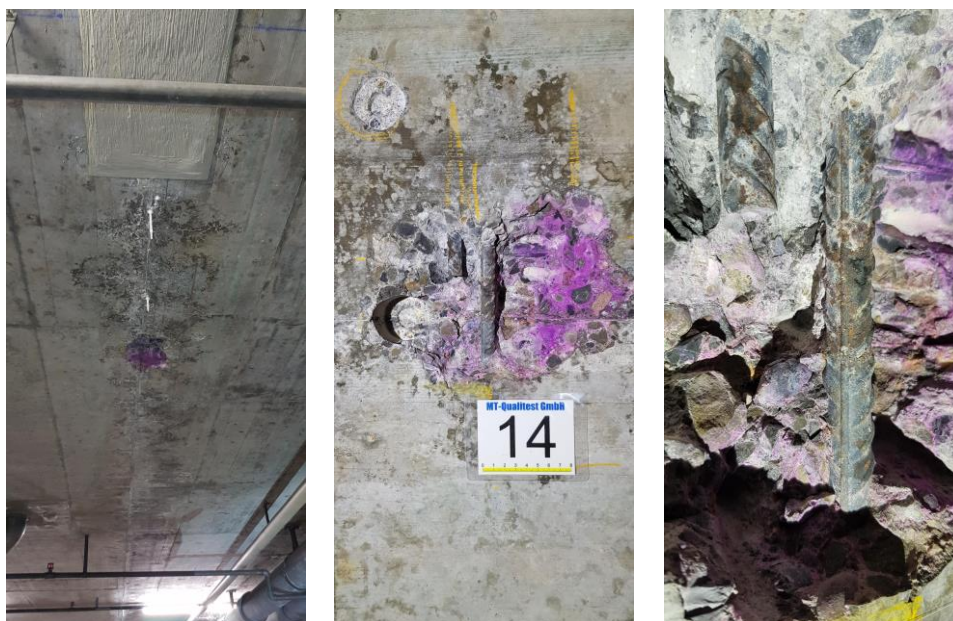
Sondagestelle S-114, Untersicht Decke UG1, wasserführender Riss mit korrodierender Bewehrung [MTQ]
